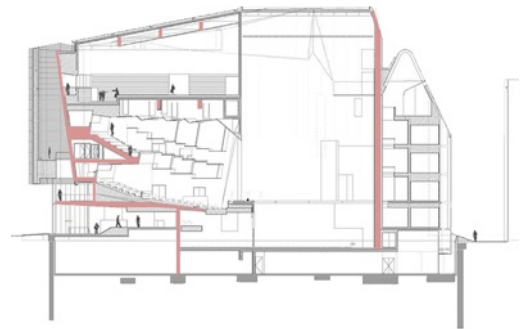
Teatro principal. Sección con elementos constructivos destacados.
